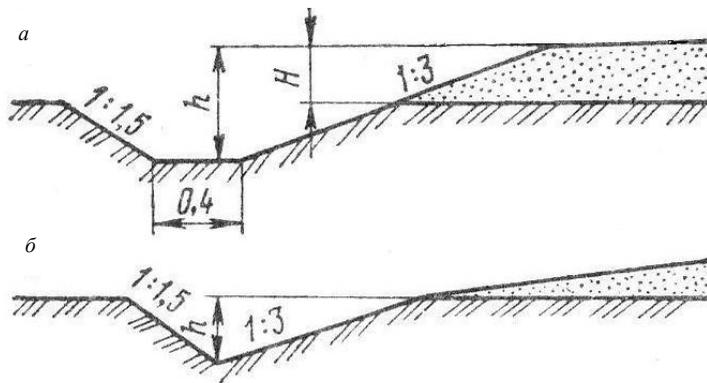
Поперечное сечение кюветов: а – трапециевидное; б – треугольное
